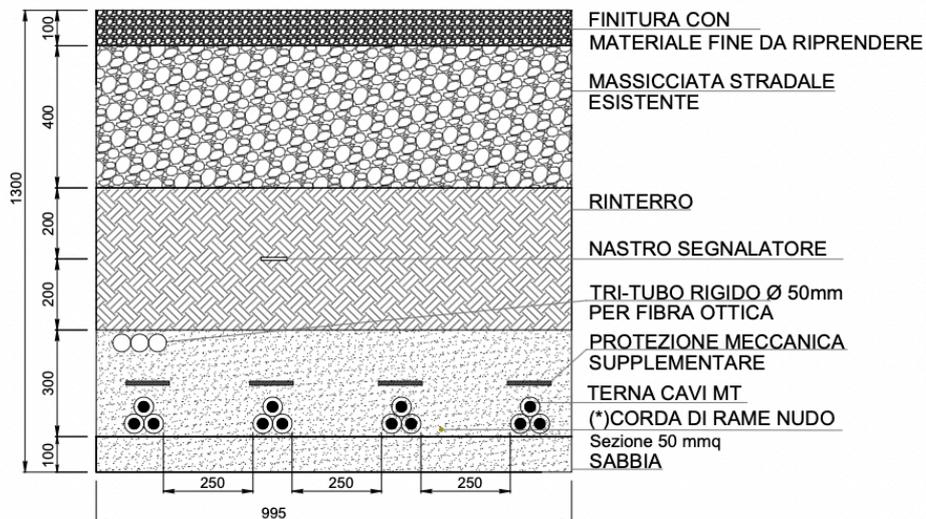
Sezione F-F: di posa 4 terne su strada esistente da adeguare
